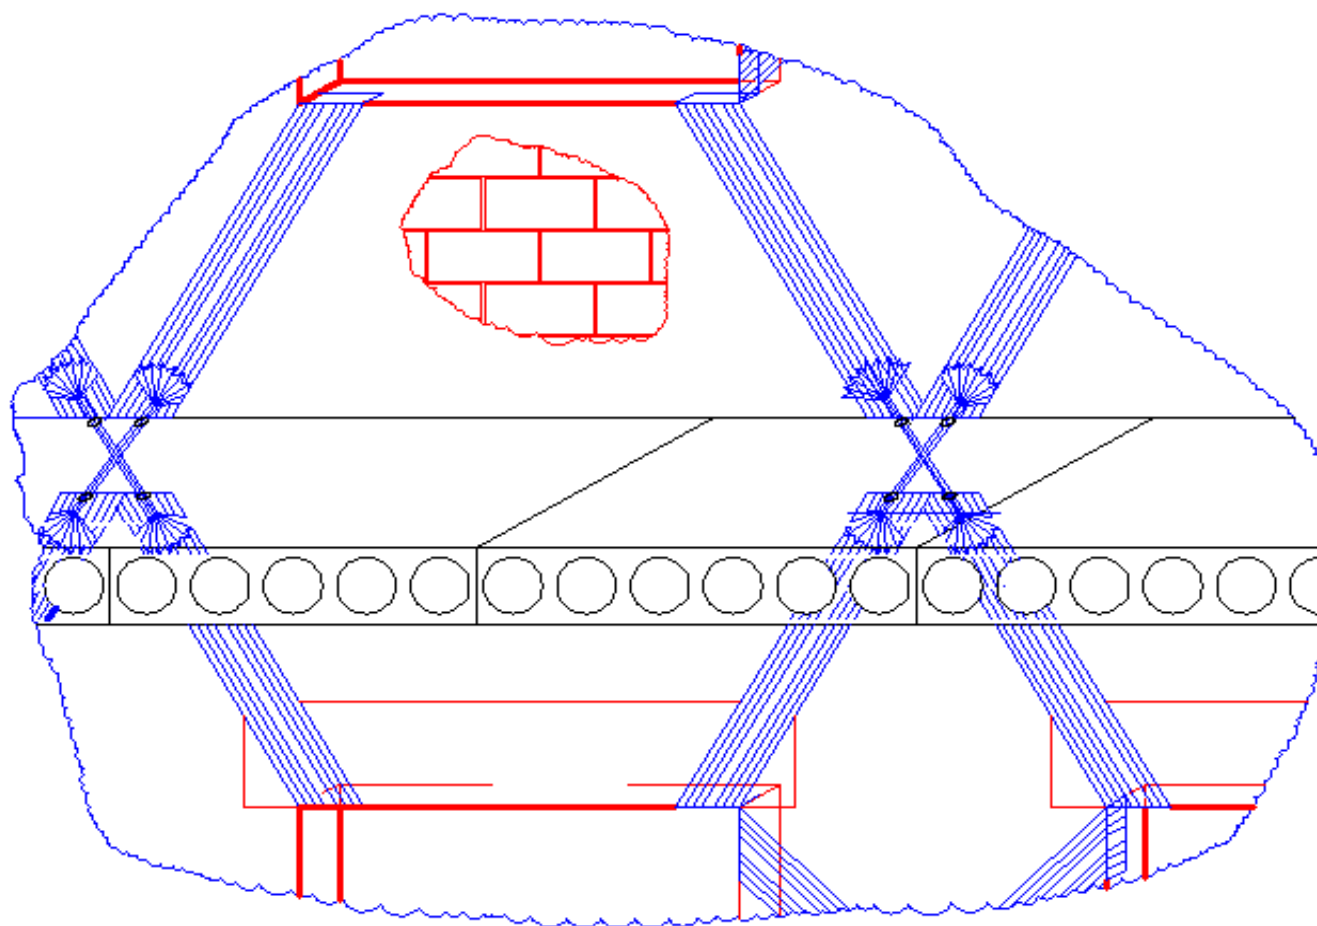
Узел прохода через перекрытие системой внешнего армирования при наклейке холстов из базальтового волокна на внутреннюю поверхность стен
